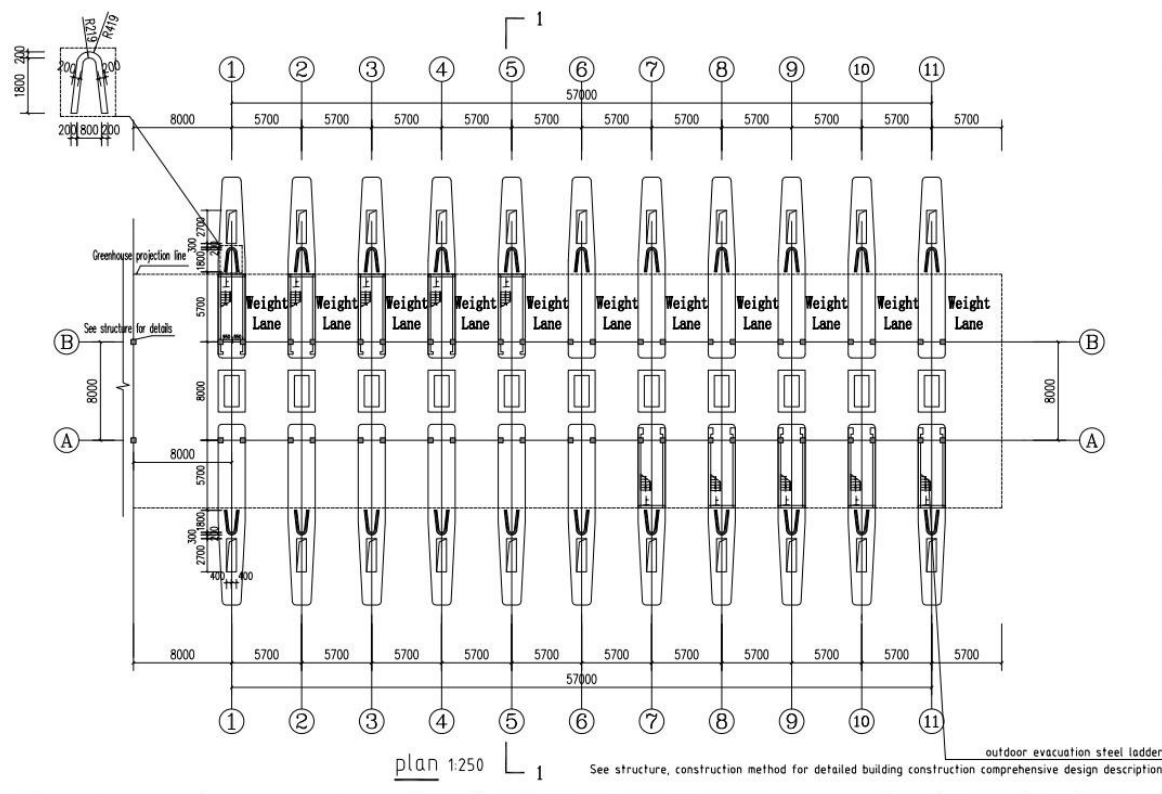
Planta de piso das portagens (fonte: projecto estrutural da portagem de Zintava da CRBC)
